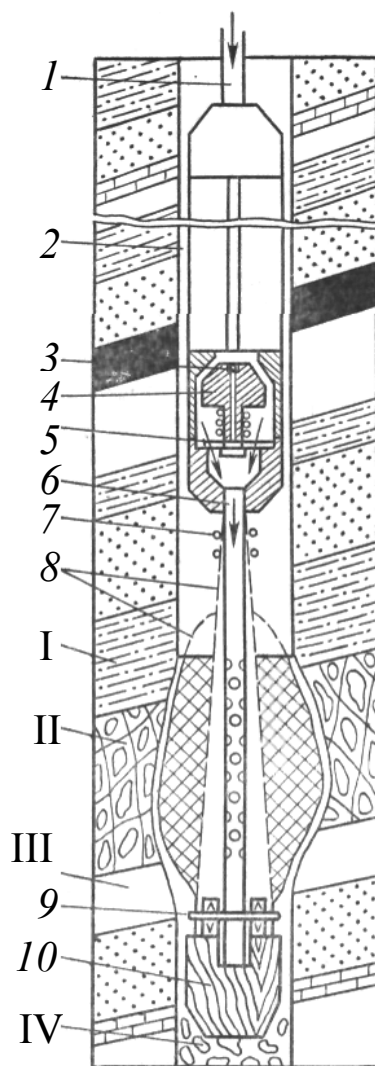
Схема установки устройства перекрытия горных выработок УПГВ-1: I, III – соответственно кровля и почва горной выработки; II – горная выработка; IV – забой скважины; 1 – буровая труба; 2 – снаряд УТС-2М; 3 – шарик; 4 – клапан смесителя; 5 – смесительная камера; 6 – перфорированная труба; 7 – резиновое кольцо; 8 – эластичная оболочка; 9 – алюминиевая шпилька; 10 – пробка-центратор
